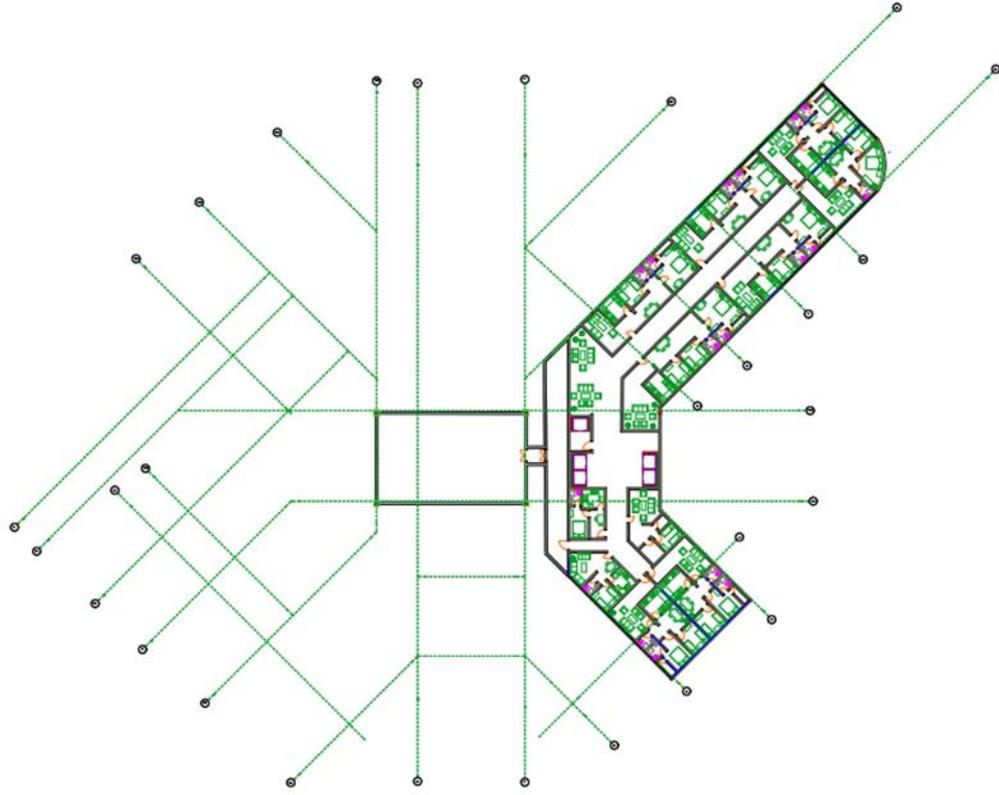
توضح المسقط الافقي للطوابق 5-8-11-14
